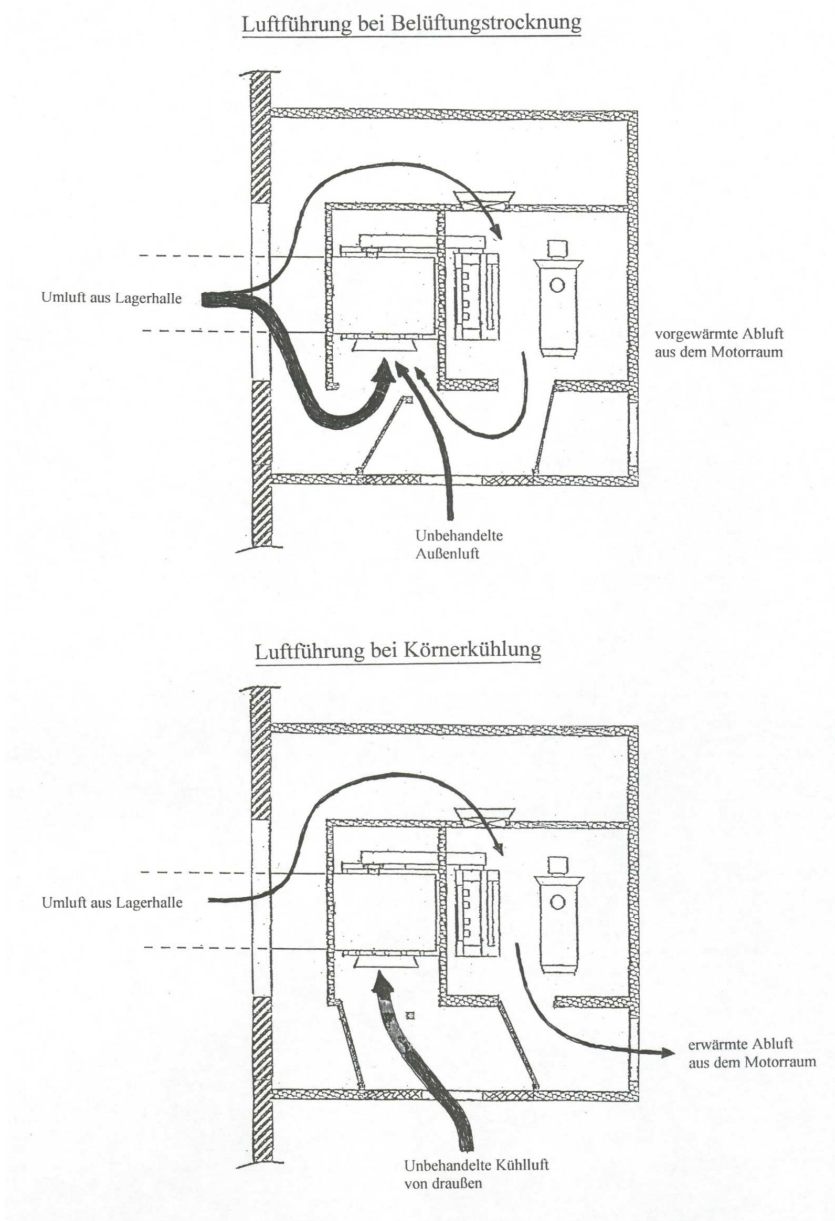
Luftführung für die Belüftungstrocknung und für Körnerkühlung im Anbau für eine Umluftanlage
